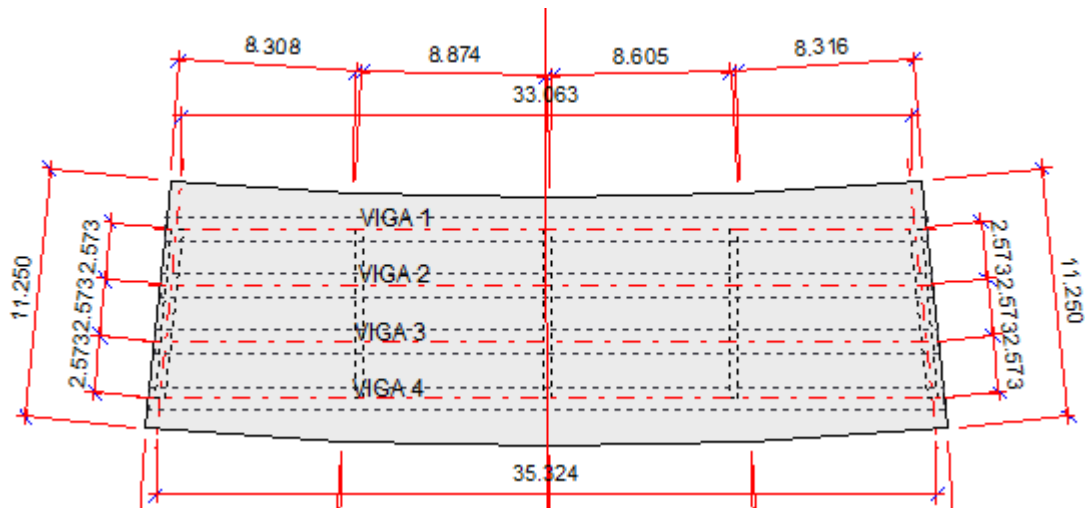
Planta de estructura. Fuente: IDOM-DEHC.
